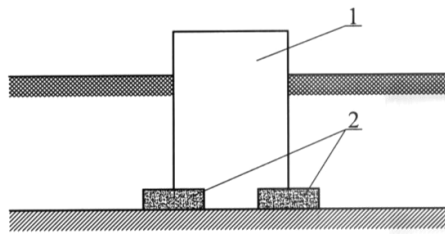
Усиление ленточного фундамента уширением подошвы: 1 – существующий ленточный фундамент; 2 - железобетонная балка по вытрамбованной щебеночной подготовке
